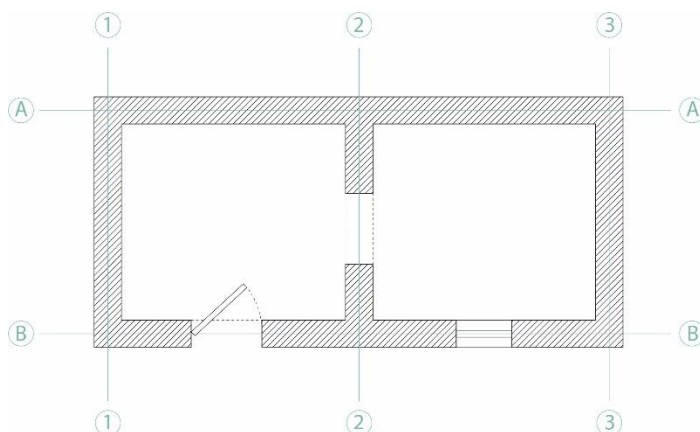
Elaboración propia. Plano de planta vivienda de dos ambientes.
